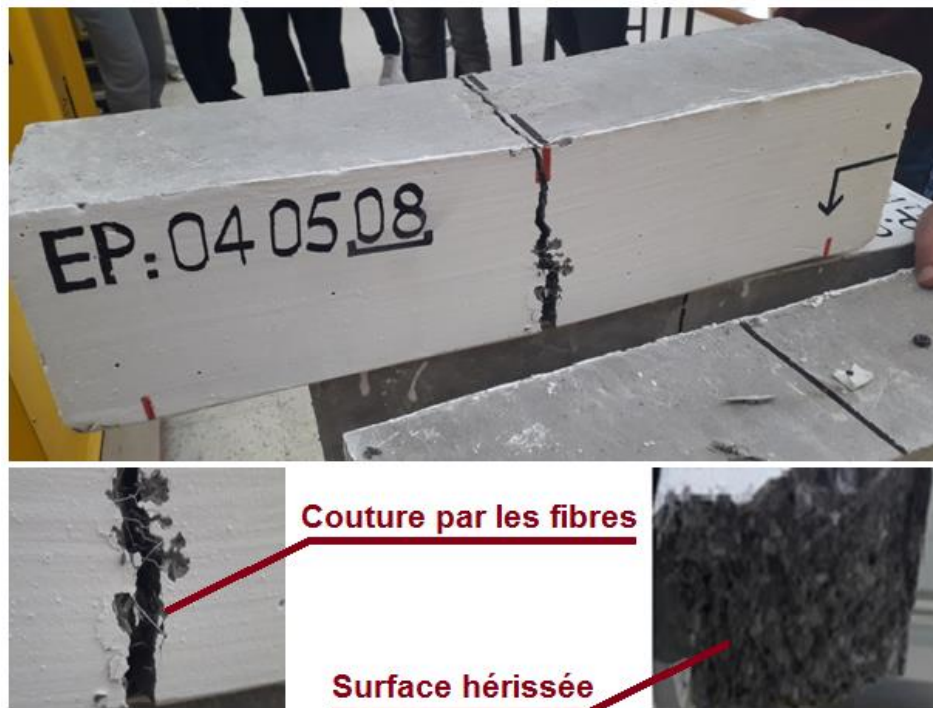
Mode de rupture des poutres en béton (témoin)
